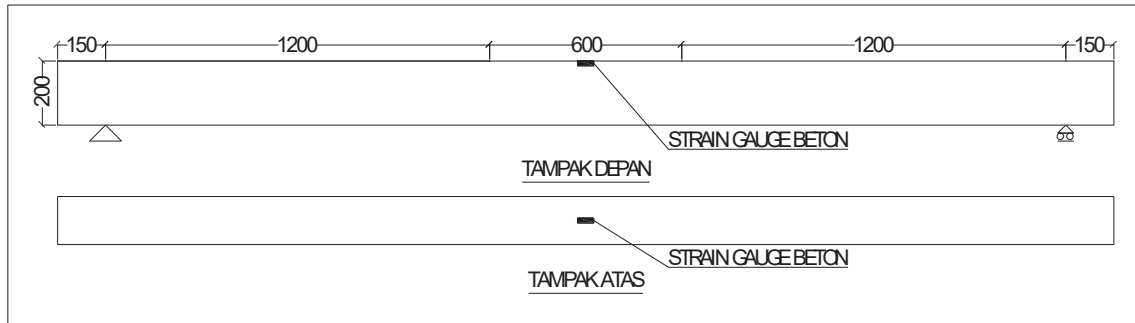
Detail benda uji – BGN (Balok Grouting Normal)
